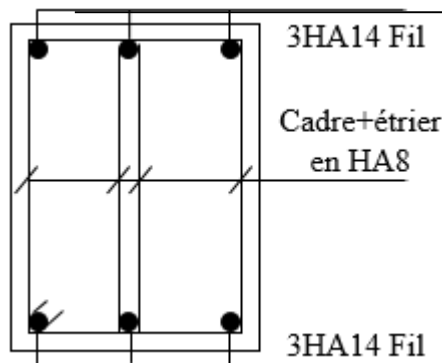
Ferraillage aux appuis d'une poutre palière.
